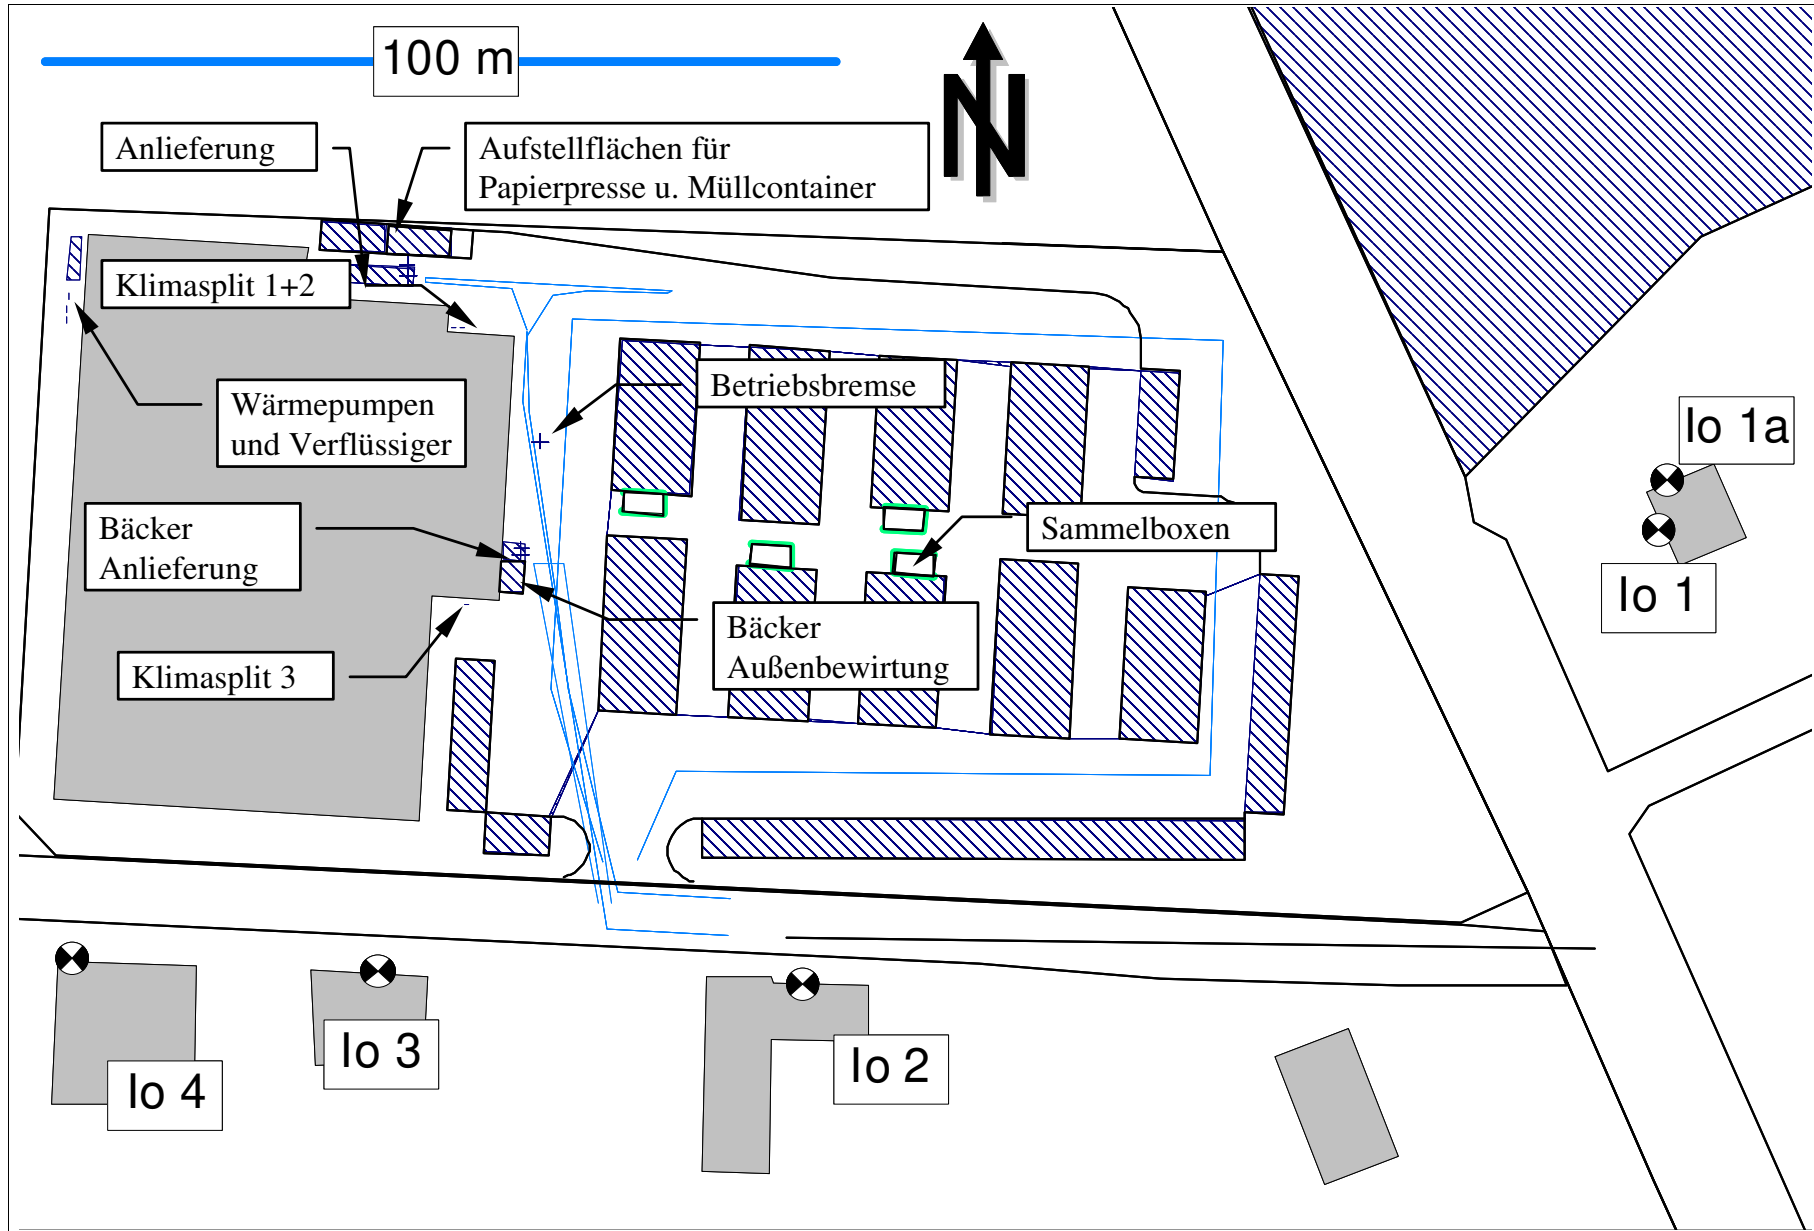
Lageplan mit Kennzeichnung der Quellen und Immissionsorte.
